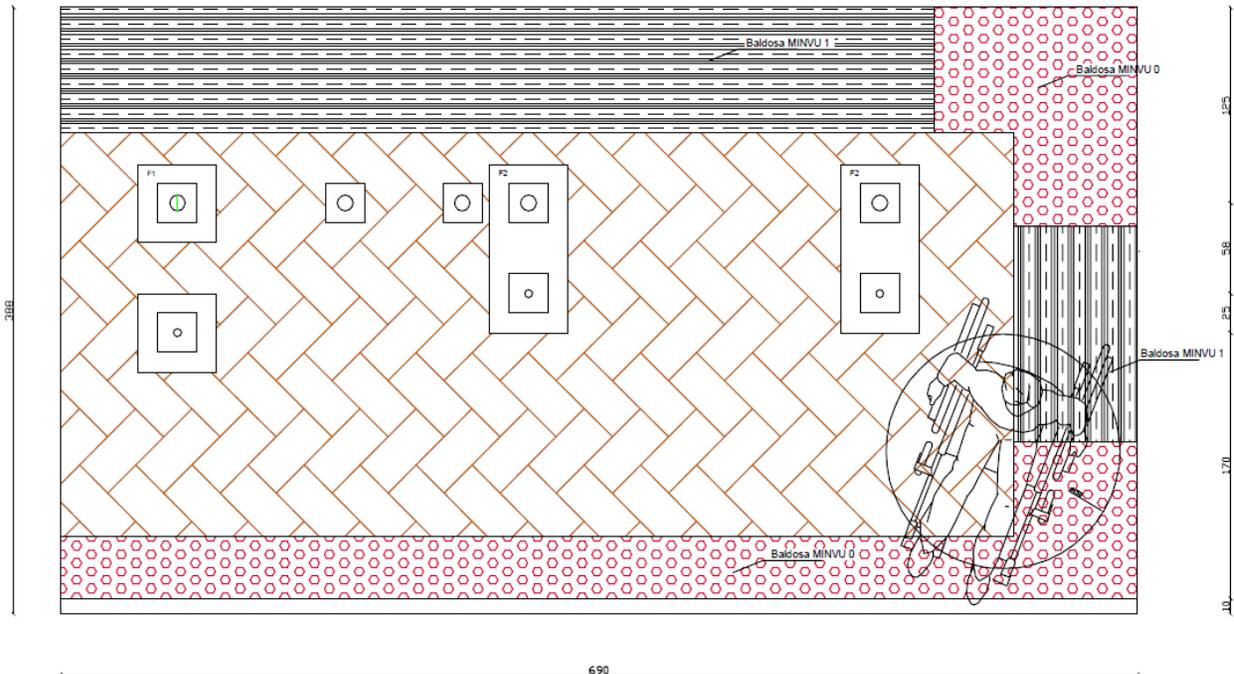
Dimensiones Pre-diseño del paradero Doble, Planta
